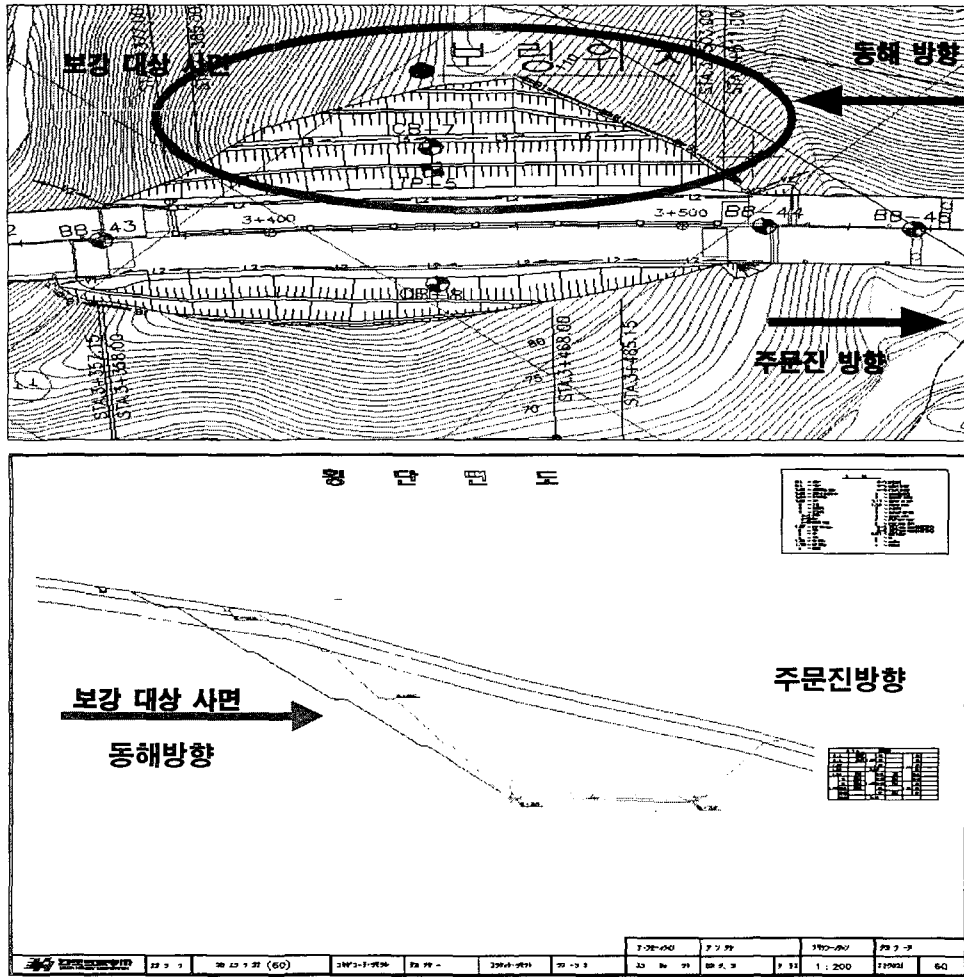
제2구간 동해방향 보강 사면의 평면도 및 단면도
